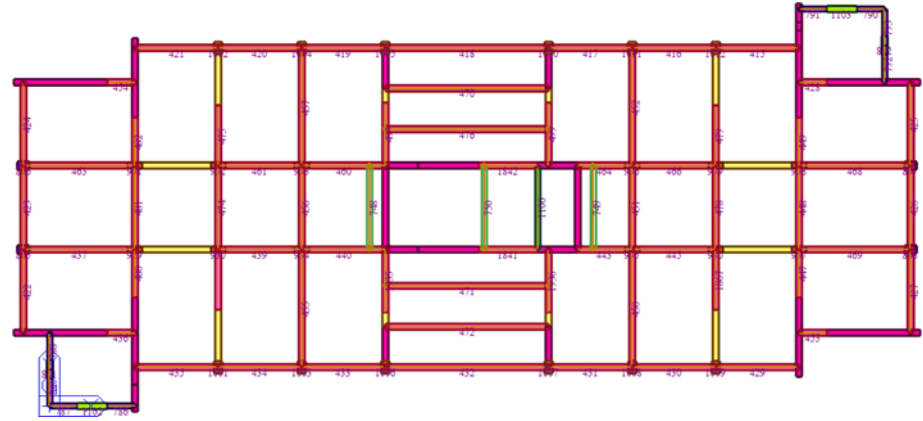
Statik analiz modelinde yapının 1. normal kat tavan kalıp planı
